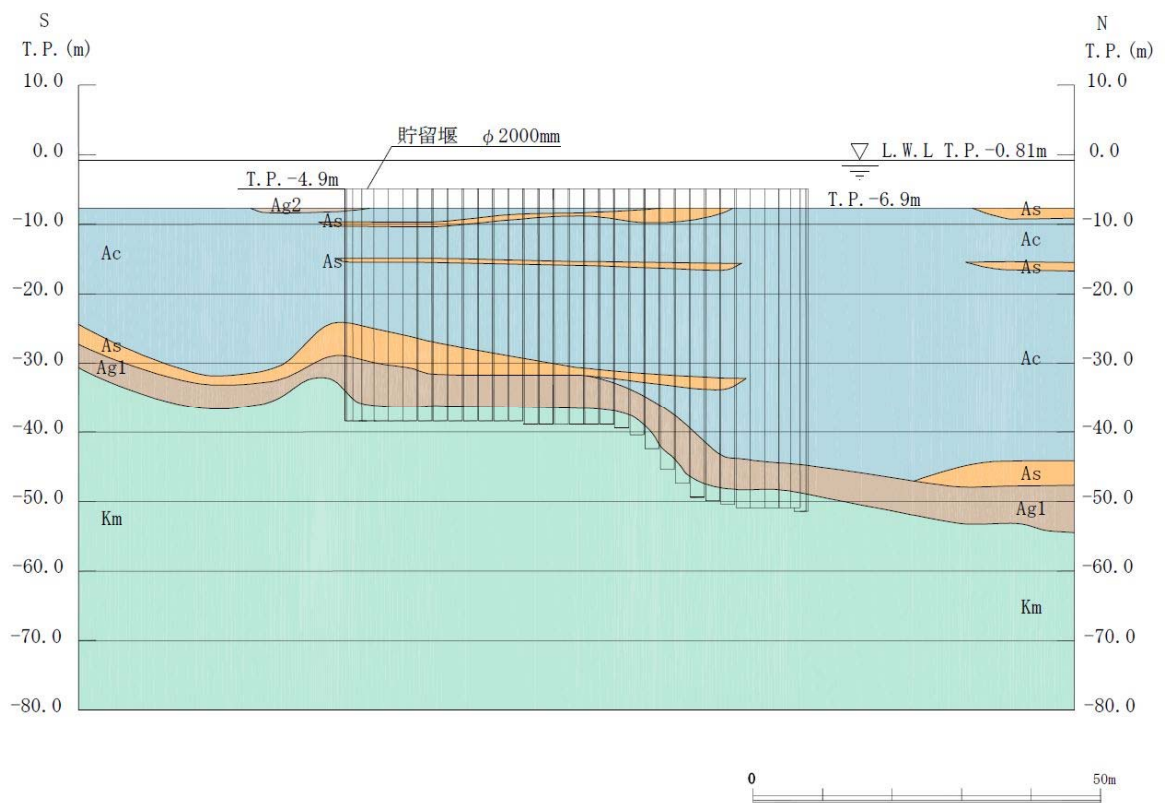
(1) 貯留堰の縦断断面図 (A-A 断面)
